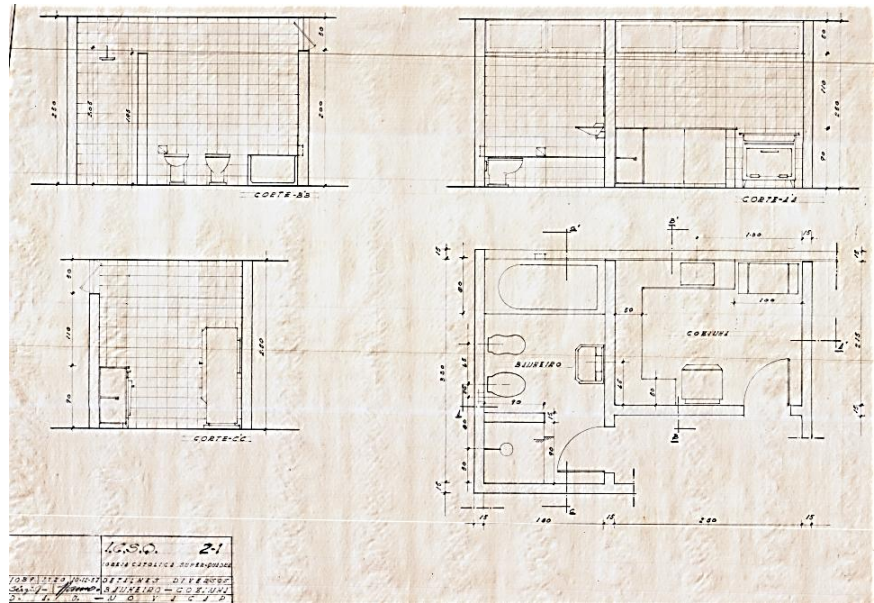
| Detalhes diversos banheiro e cozinha. 10.12.1957
